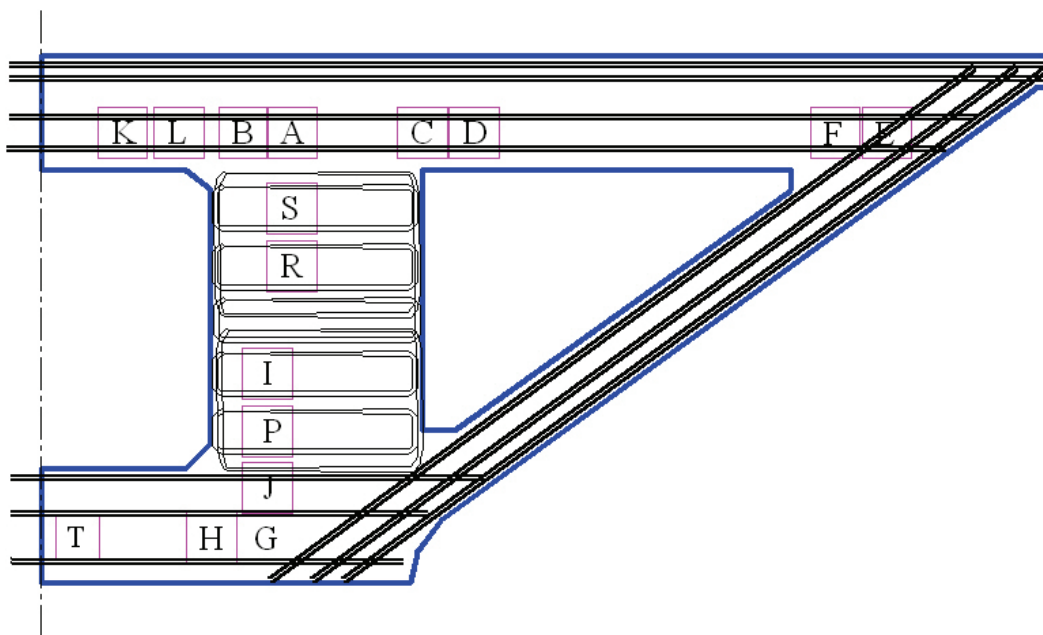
Principe de ferrailage - première zone (section renforcée)
